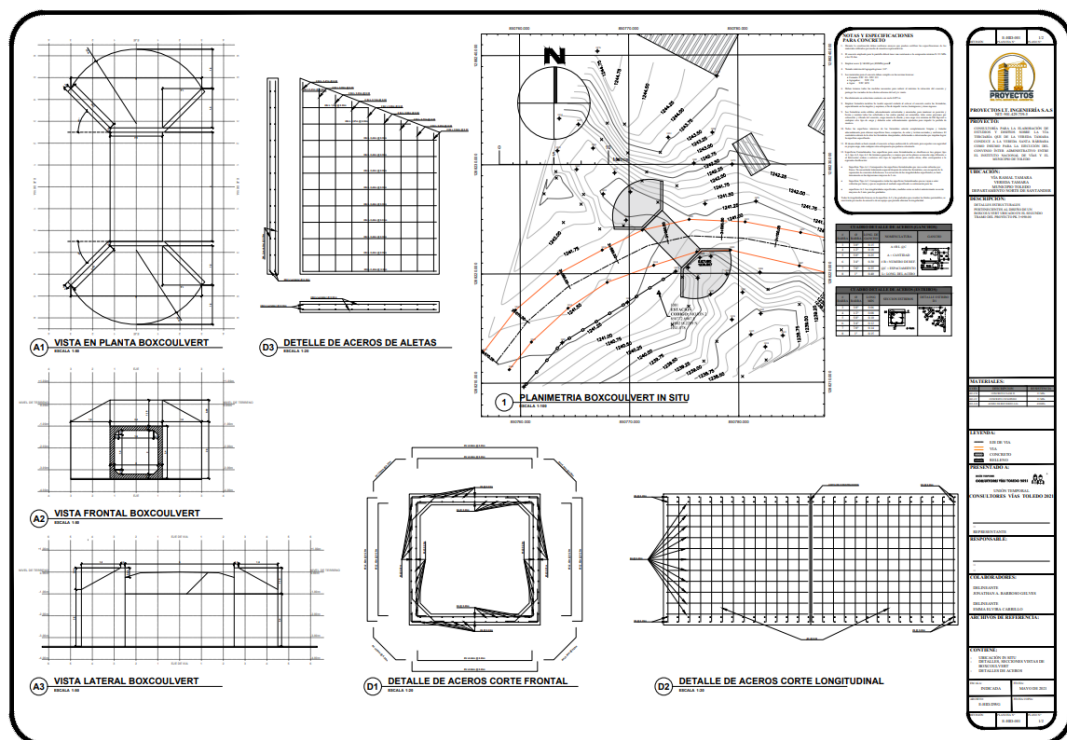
Planos estructurales de box culvert tramo 1fuente (propia).
